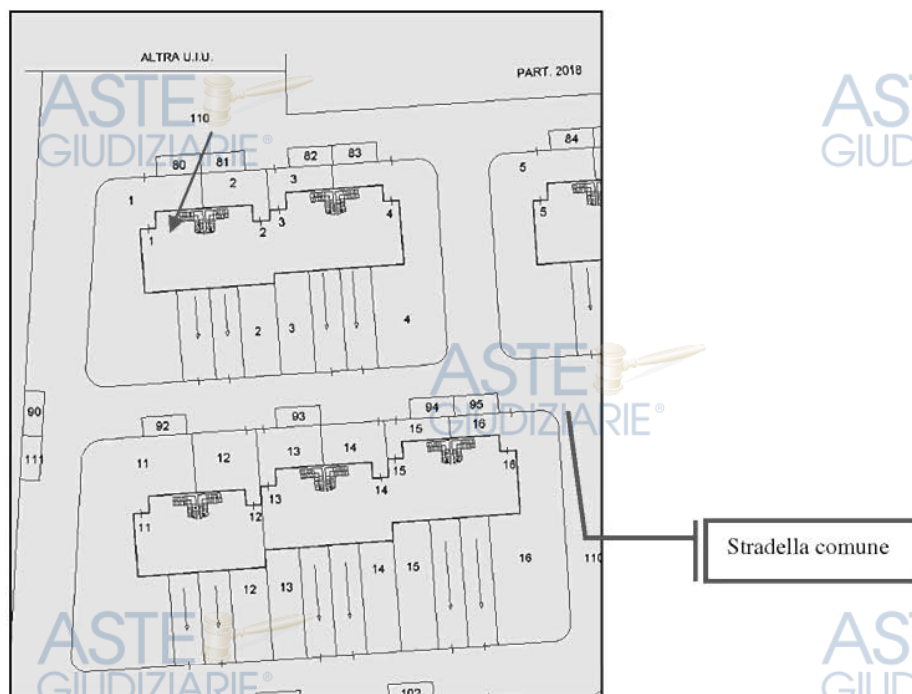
Visualizzazione dei beni oggetto della presente sezione- piano terra
